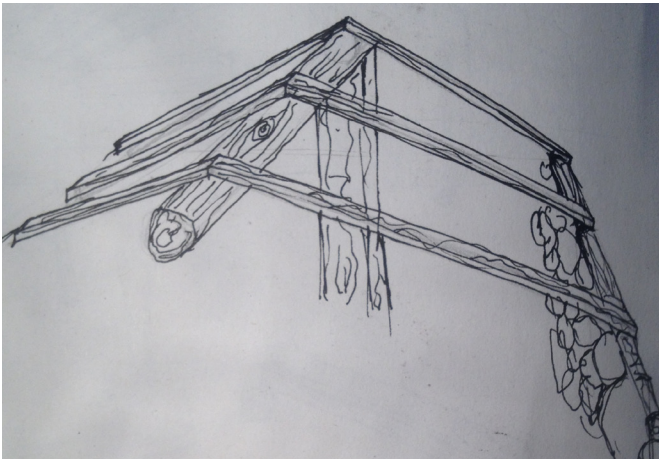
/37 – Interior dos currais, mau estado das paredes, da cobertura e do pavimento
